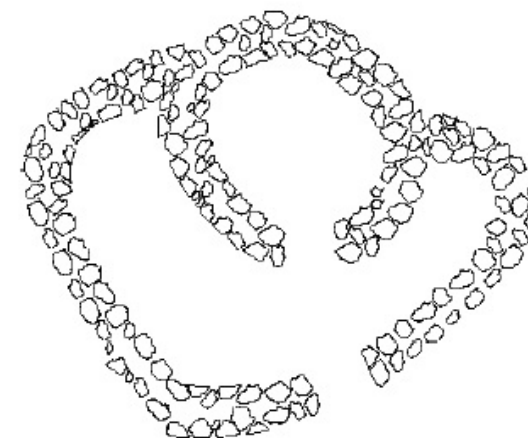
Ruinas Shabalula, planta de una construcción Cañari.
